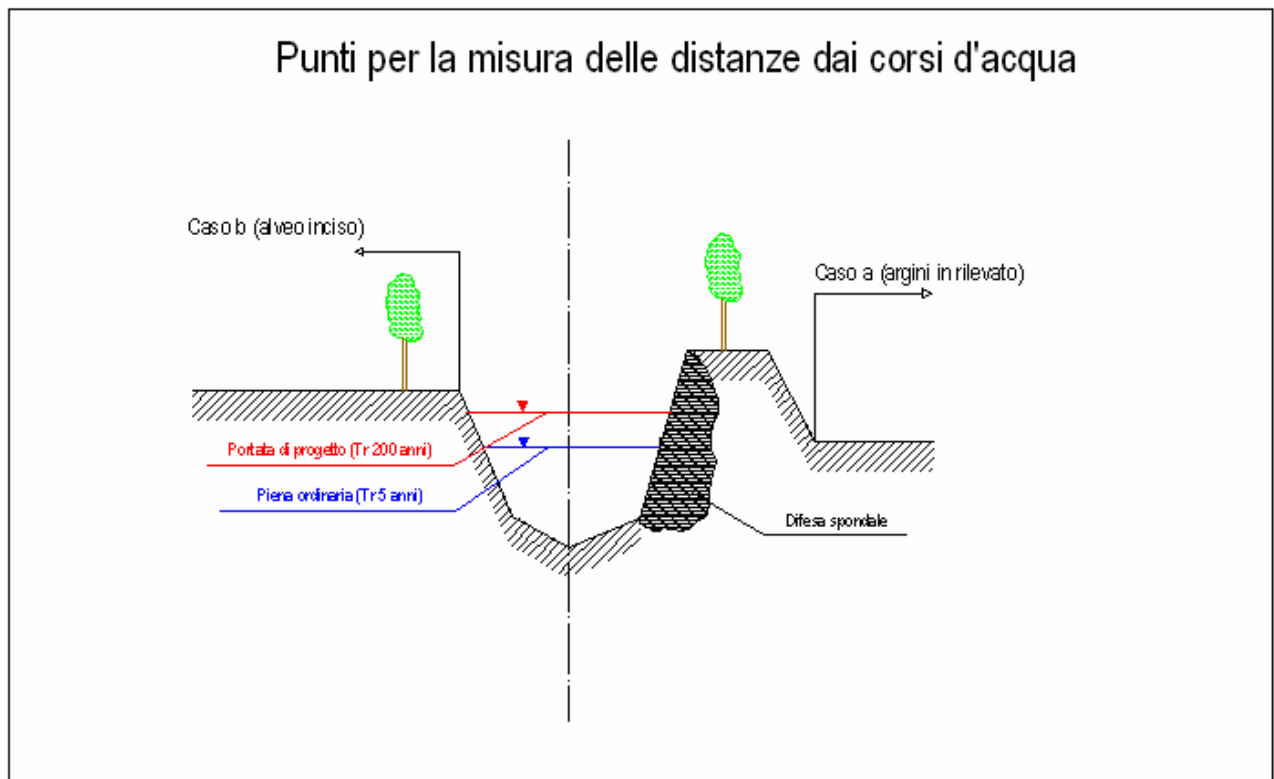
Sezione tipo di alveo fluviale con individuazione dei punti per la misurazione delle distanze
